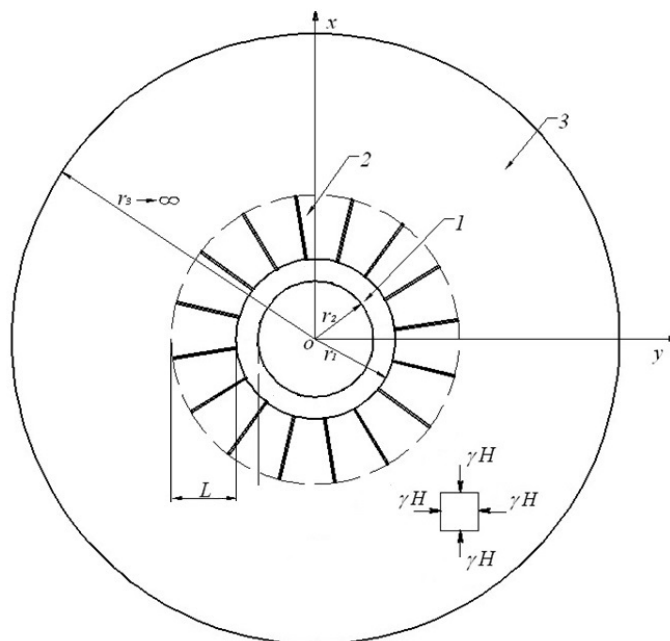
Расчетная схема анкерно-бетонной крепи подземного сооружения:
